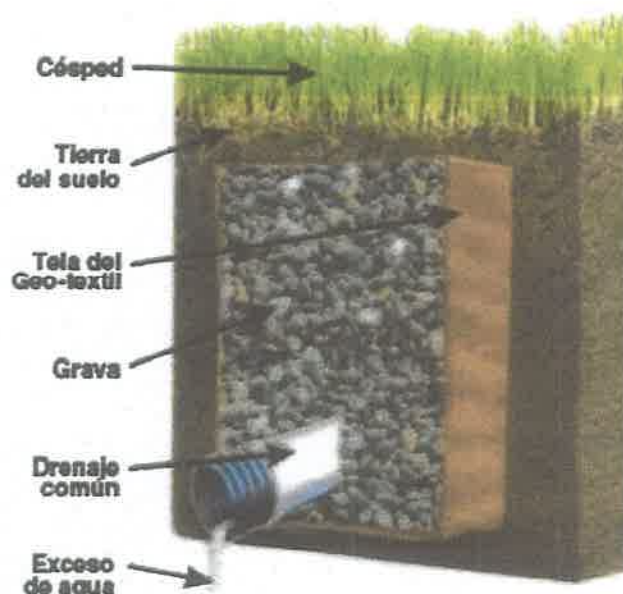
Detalle típico de drenaje francés (Fuente: <https://www.pinterest.com.mx>)
